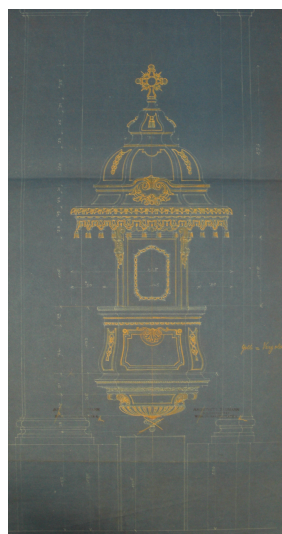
Kanzel mit Plan und Detail Schalldeckel
